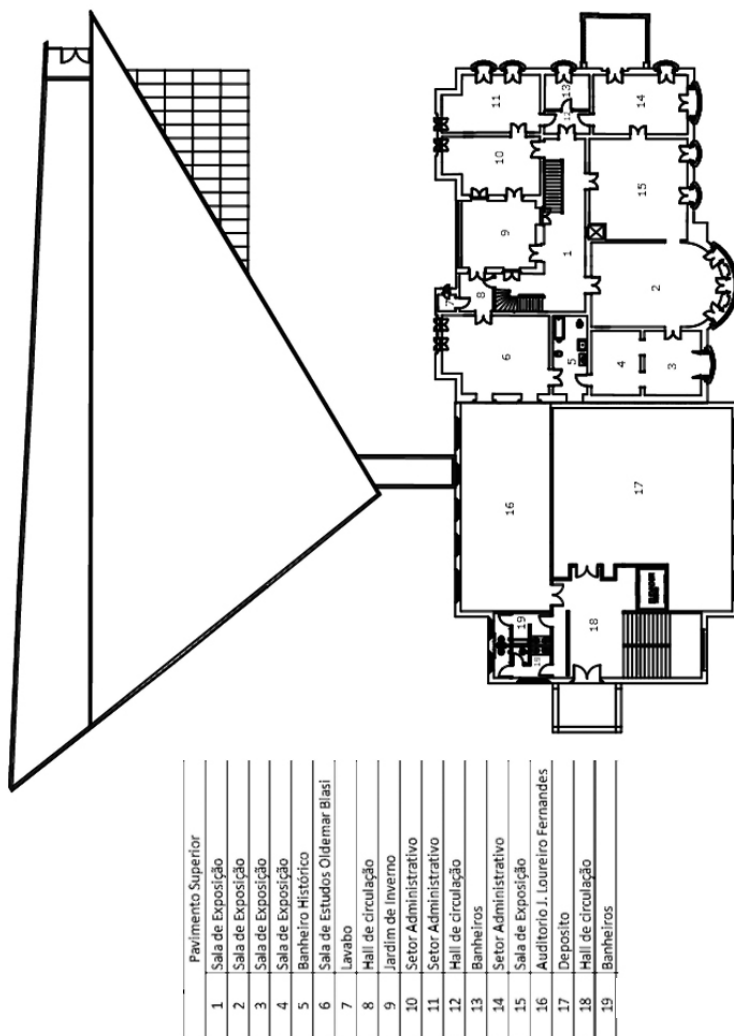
Planta baixa pavimento superior do Museu Paranaense.¹³⁹
